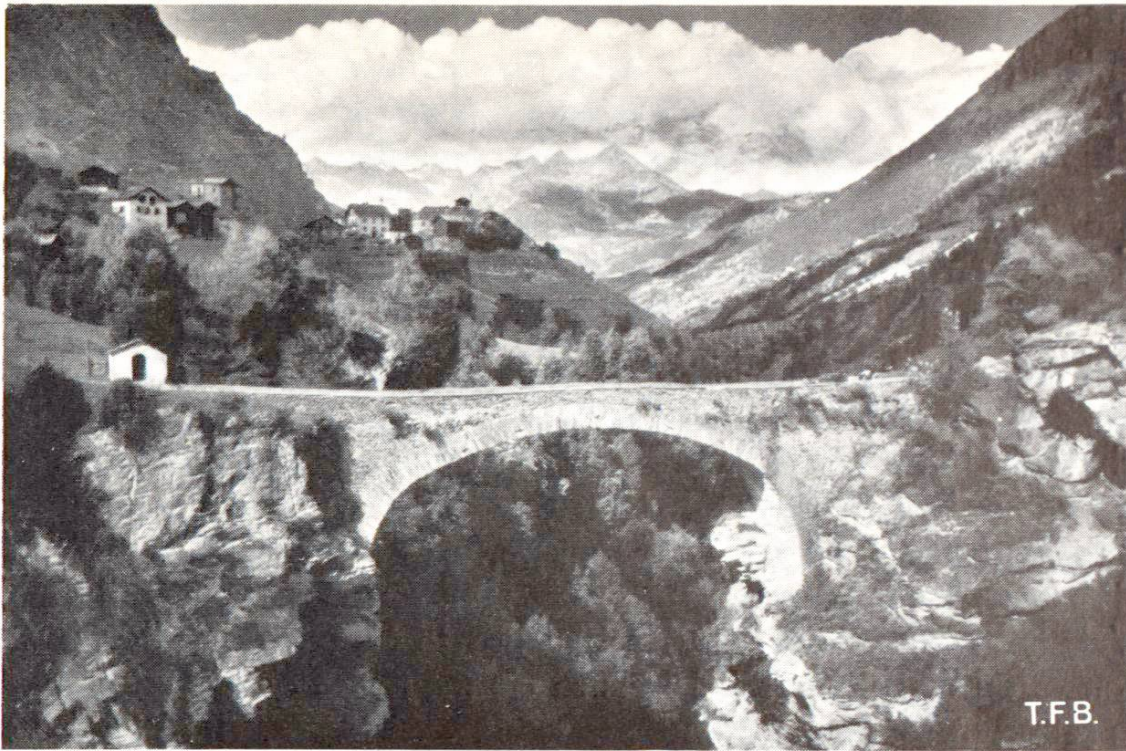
Pont sur la Viège à Stalden. Maçonnerie en chaux hydraulique construite de 1544 à 1546
